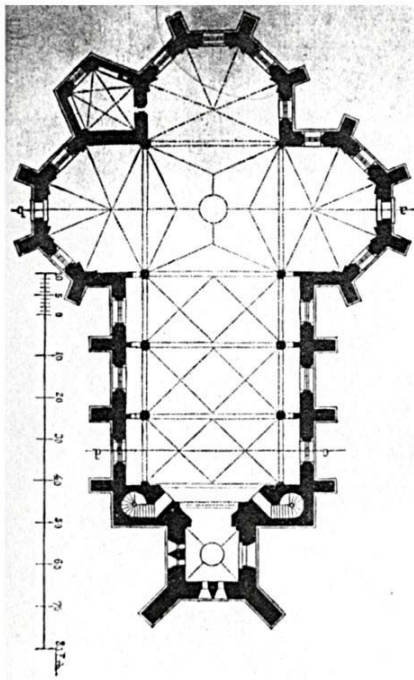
Grundriss, Zustand bei Fertigstellung ohne
